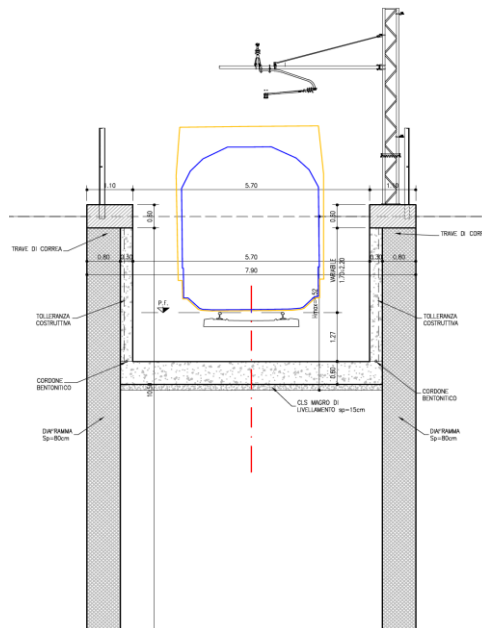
Scavo con diaframmi – sezione TIPO 7c
